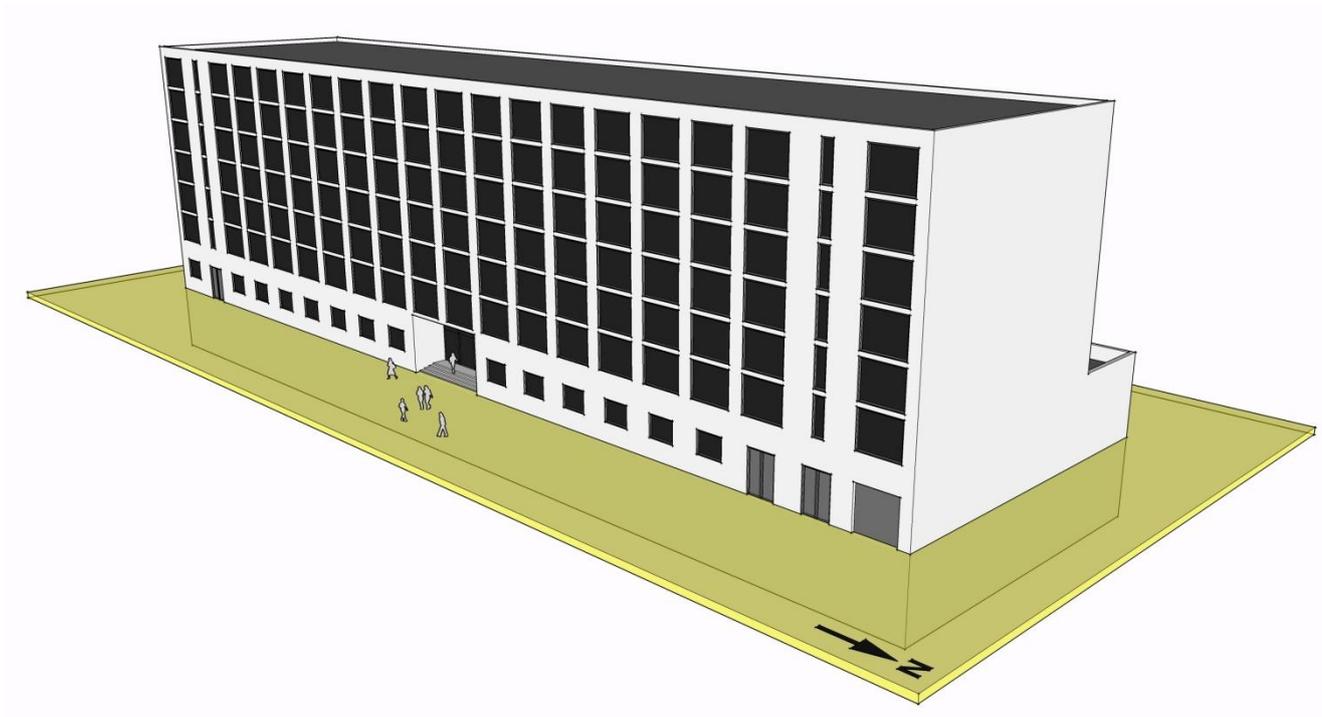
Hotels - groß – Darstellung Gebäude – Ansicht Nord-Ost
